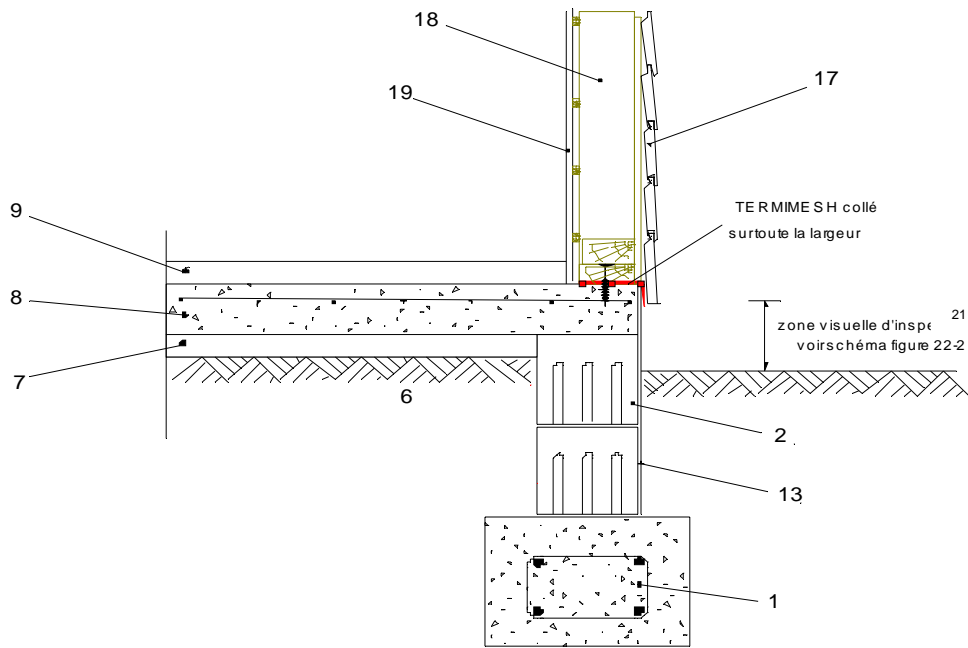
EU 1.1-8 : dallage coffré enduit de soubassement mince et élévation ossature bois
